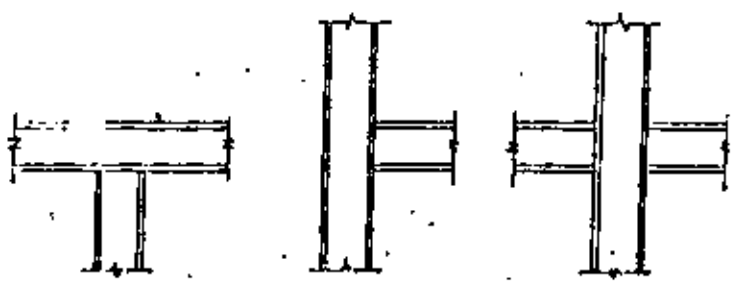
CONEXIONES VIGA-COLUMNA
